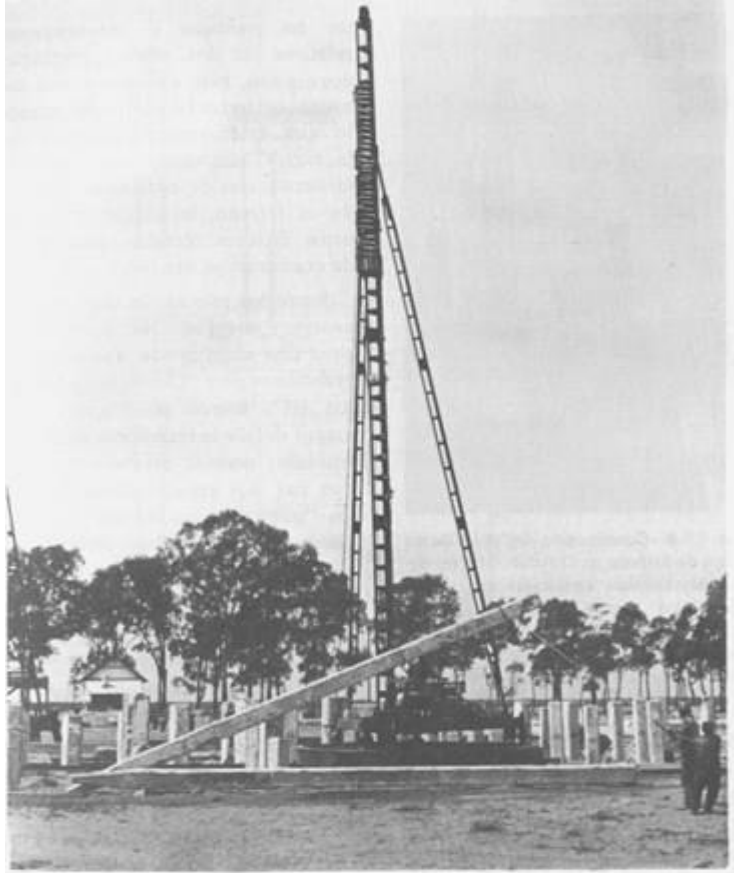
Pilote tubular de hormigón armado pretensado. (Cortesía de Entrecanales y Távora, S.A.).
